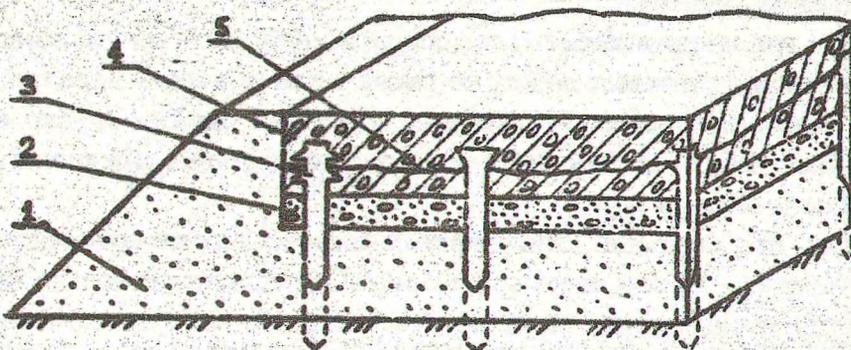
Дорожная конструкция на свайных элементах: 1 - дорожное грунтовое основание; 2 - подстилающий слой; 3 - свая; 4 - покрытие; 5 - арматура
